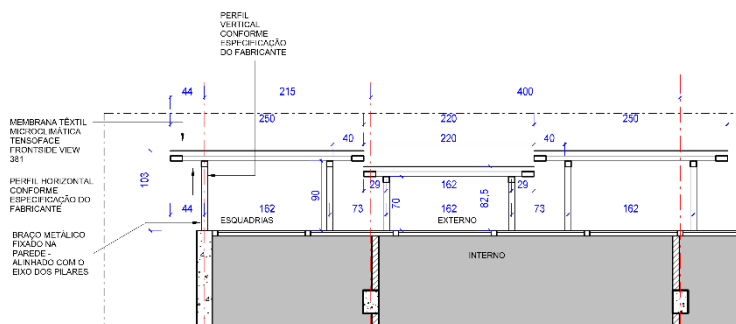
Detalhe do sistema de proteção em planta, 1º pavimento
